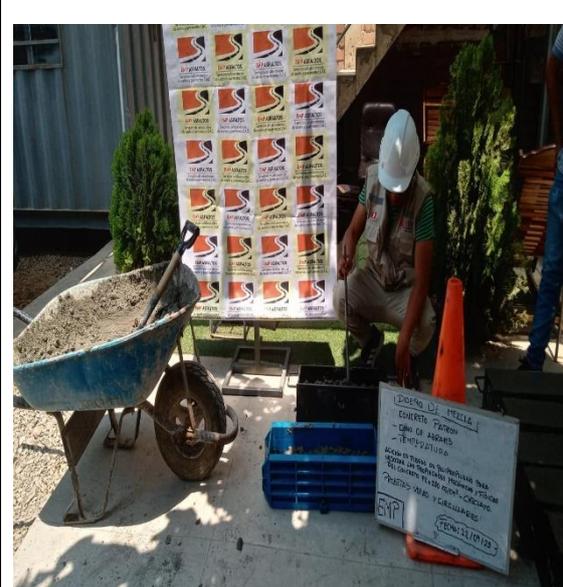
CHICLAYO. Elaboración de probetas, del concreto patrón, 2023.
